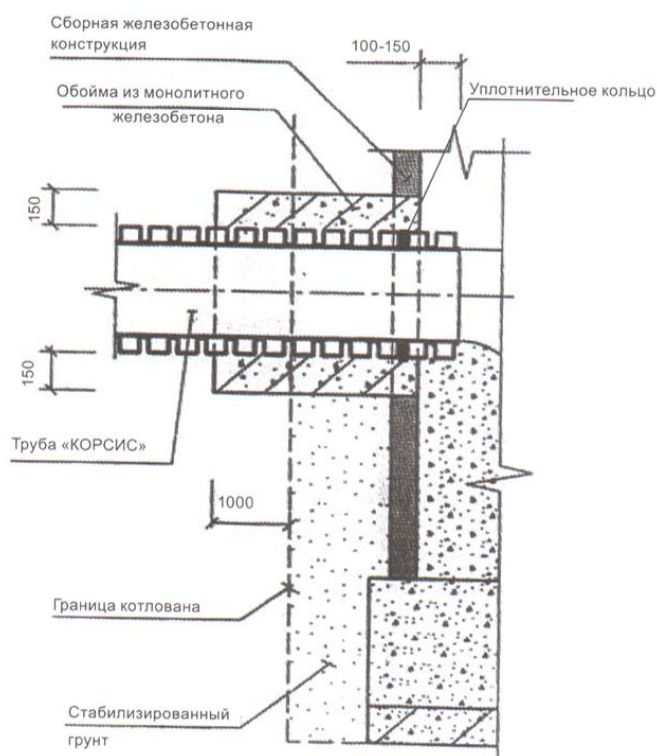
Узлы присоединения трубопроводов из труб «КОРСИС» к колодцам из элементов при устройстве перепадов
